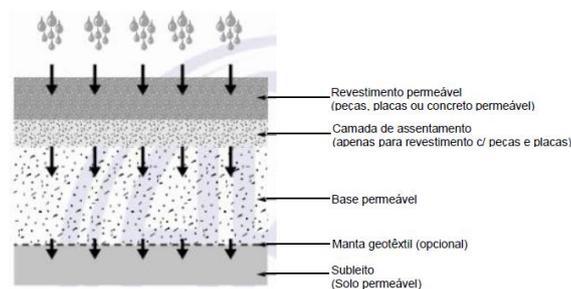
Exemplo de sistema de pavimento permeável com infiltração total. Fonte: NBR 16416 (2015).
